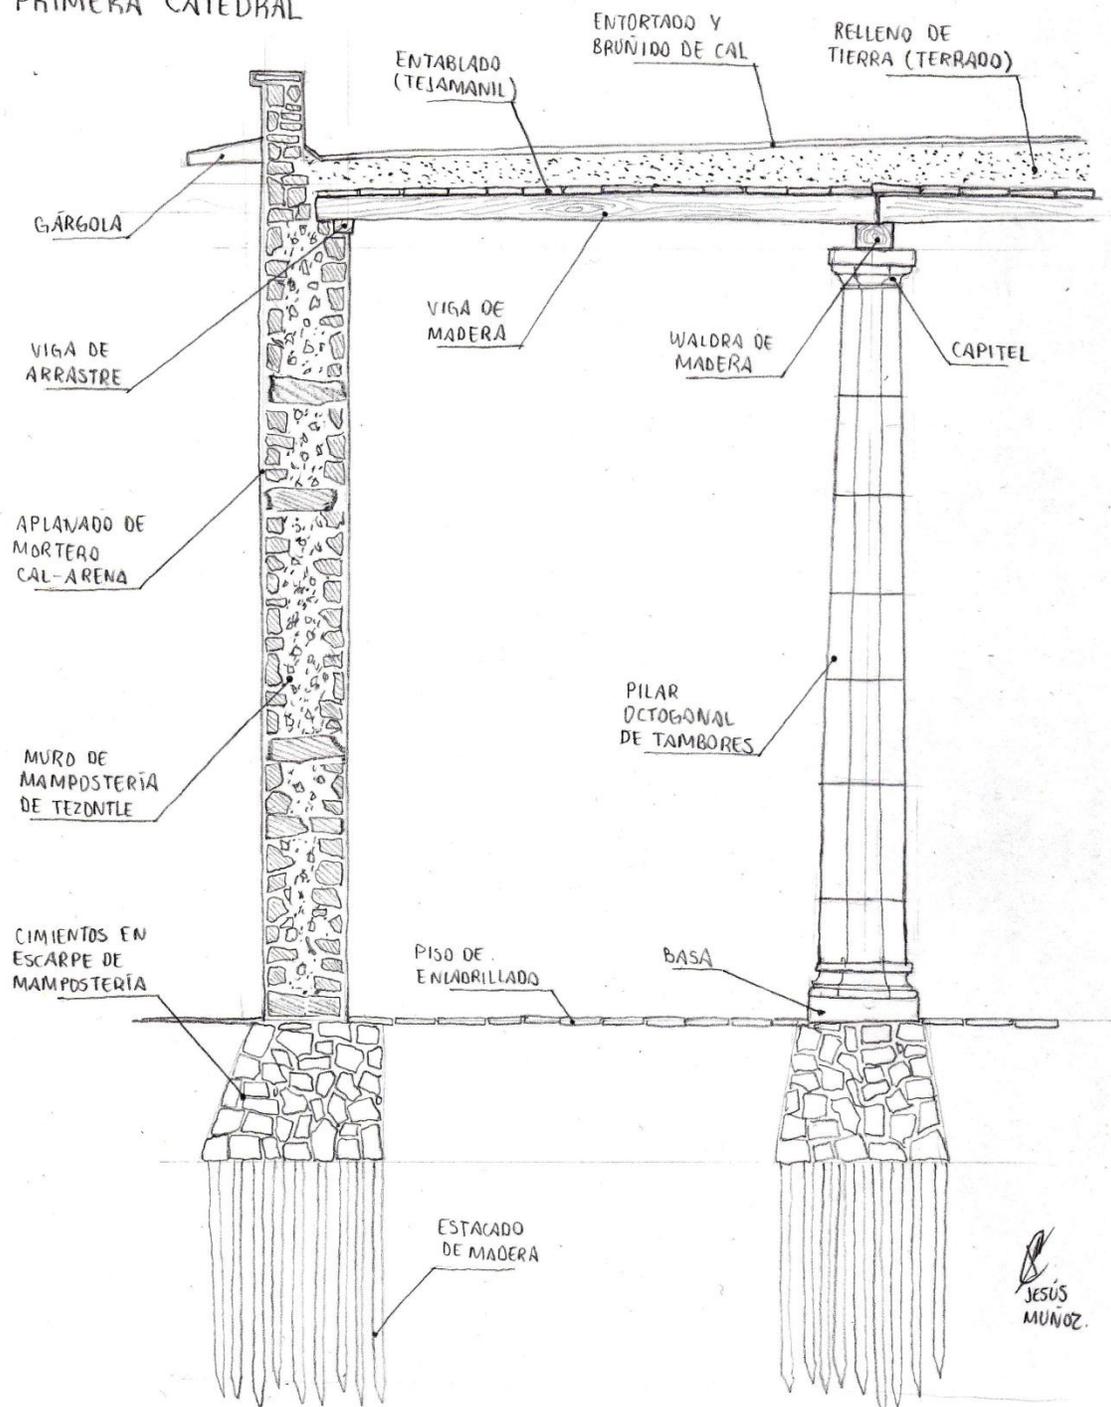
Propuesta de corte por fachada en donde se aprecian los sistemas constructivos de los cimientos y los muros de ripio o de tres capas. Elaboró por Jesús Muñoz, 2019.
